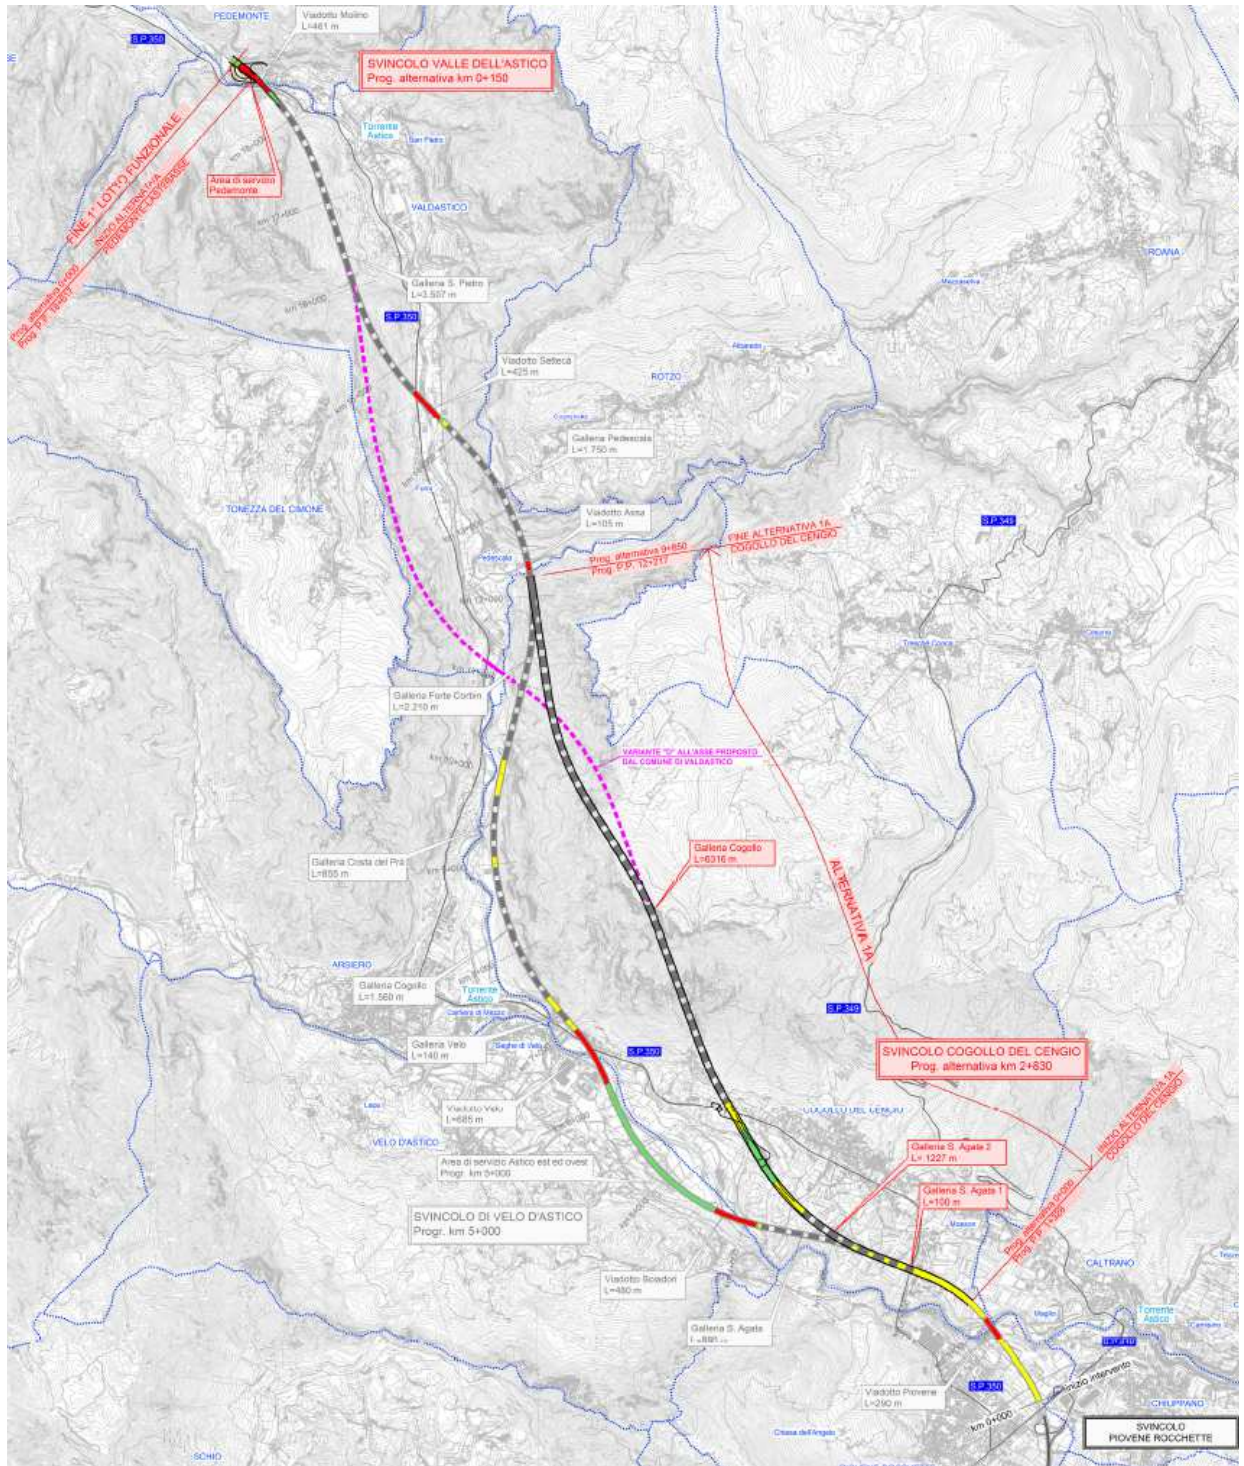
Planimetria schematica della Variante "D" (in magenta)
